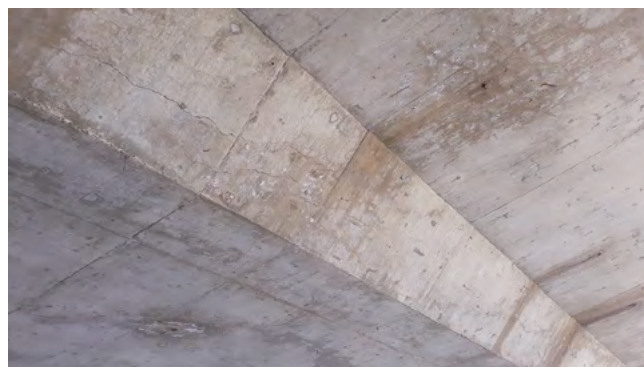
Fisuración longitudinal en el alma de una losa postesada.
